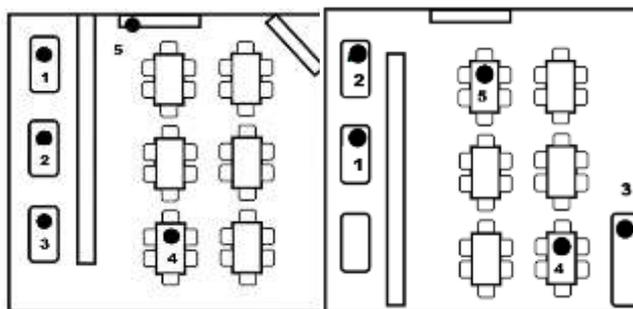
Biblioteca central de la UNJBG primera planta y segunda planta
